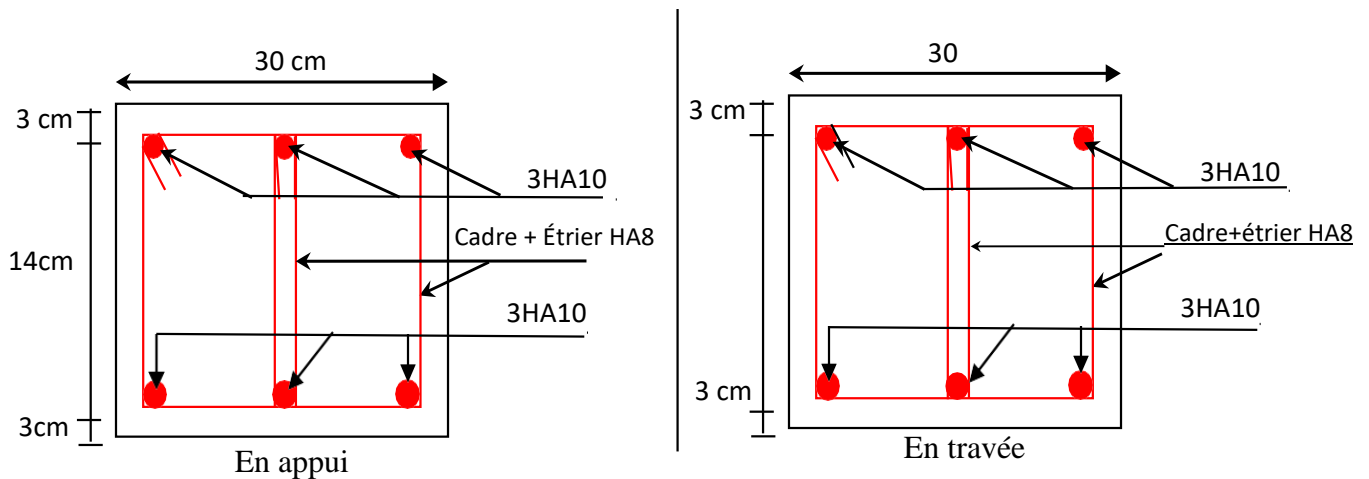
Schéma de ferrailage de la poutre de chaînage.
